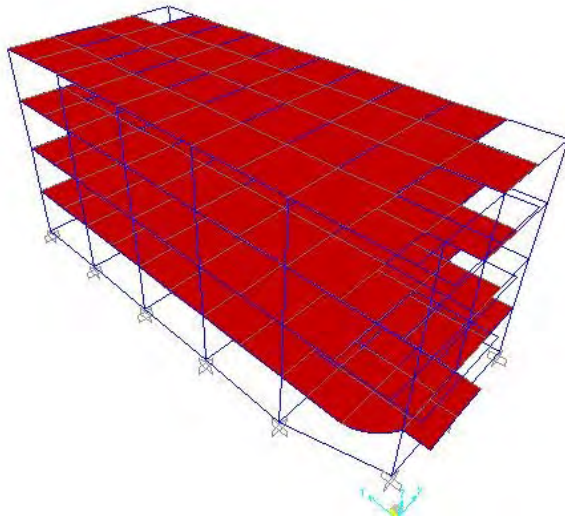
Denah Struktur Perkantoran PT. ALSTOM Surabaya
